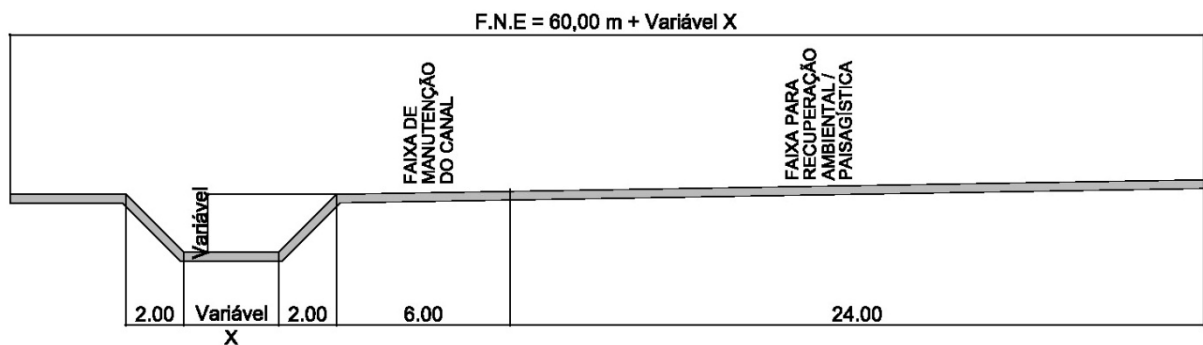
Canal em Terra. Seção Trapezoidal aberta.
